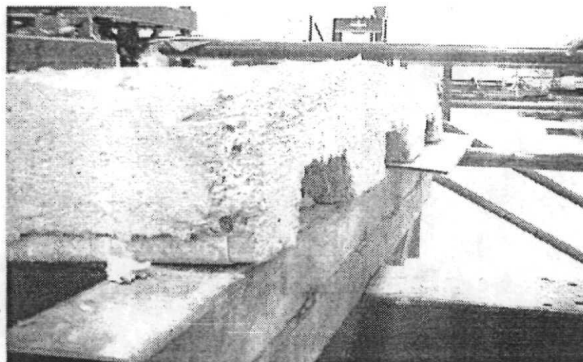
Deslizamiento de extremo debido a la pérdida de adherencia
